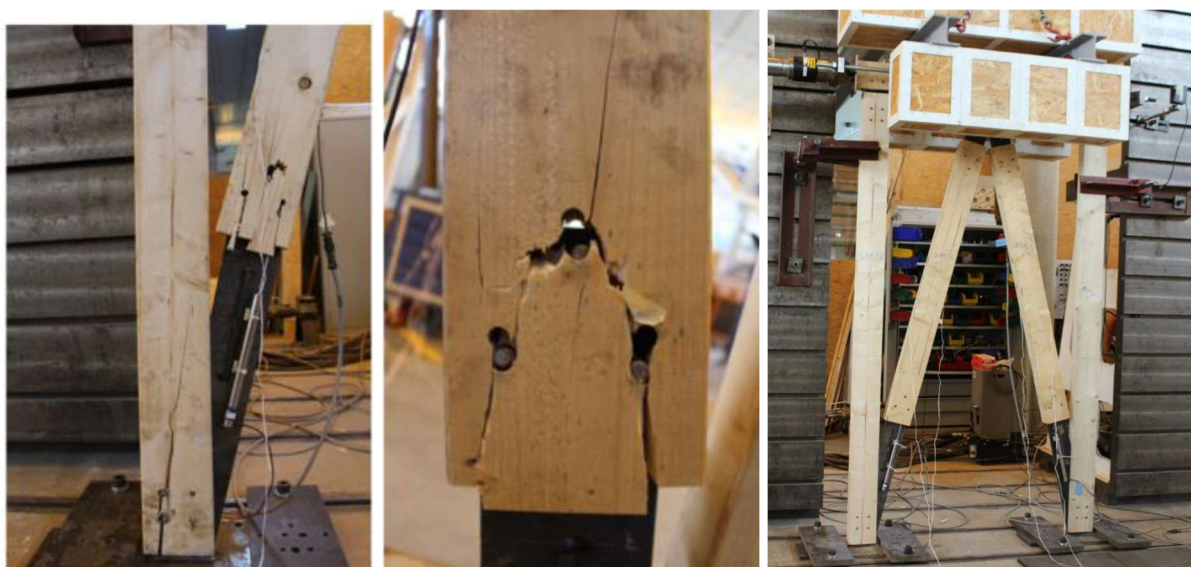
Un des portiques d'essai (à droite) Profil de rupture (à gauche et au centre)
